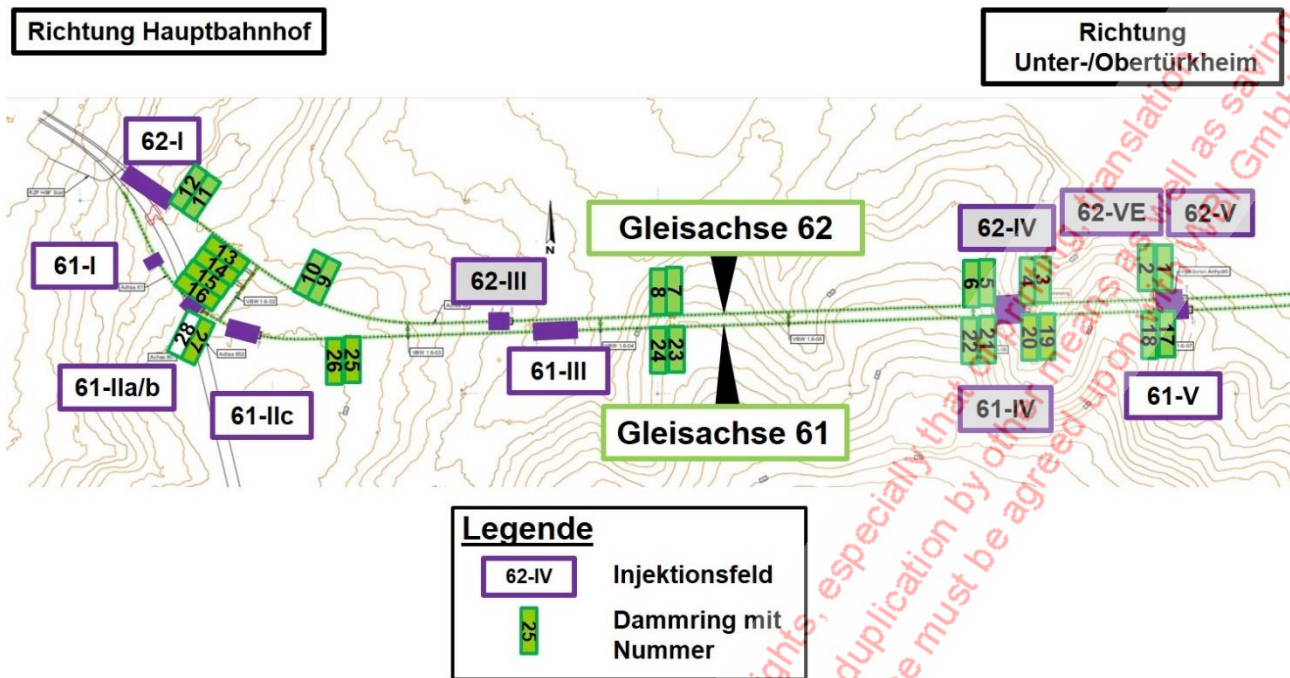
Tunnel nach Obertürkheim, Dammringe und Injektionen Anhydrit, Lageplan
